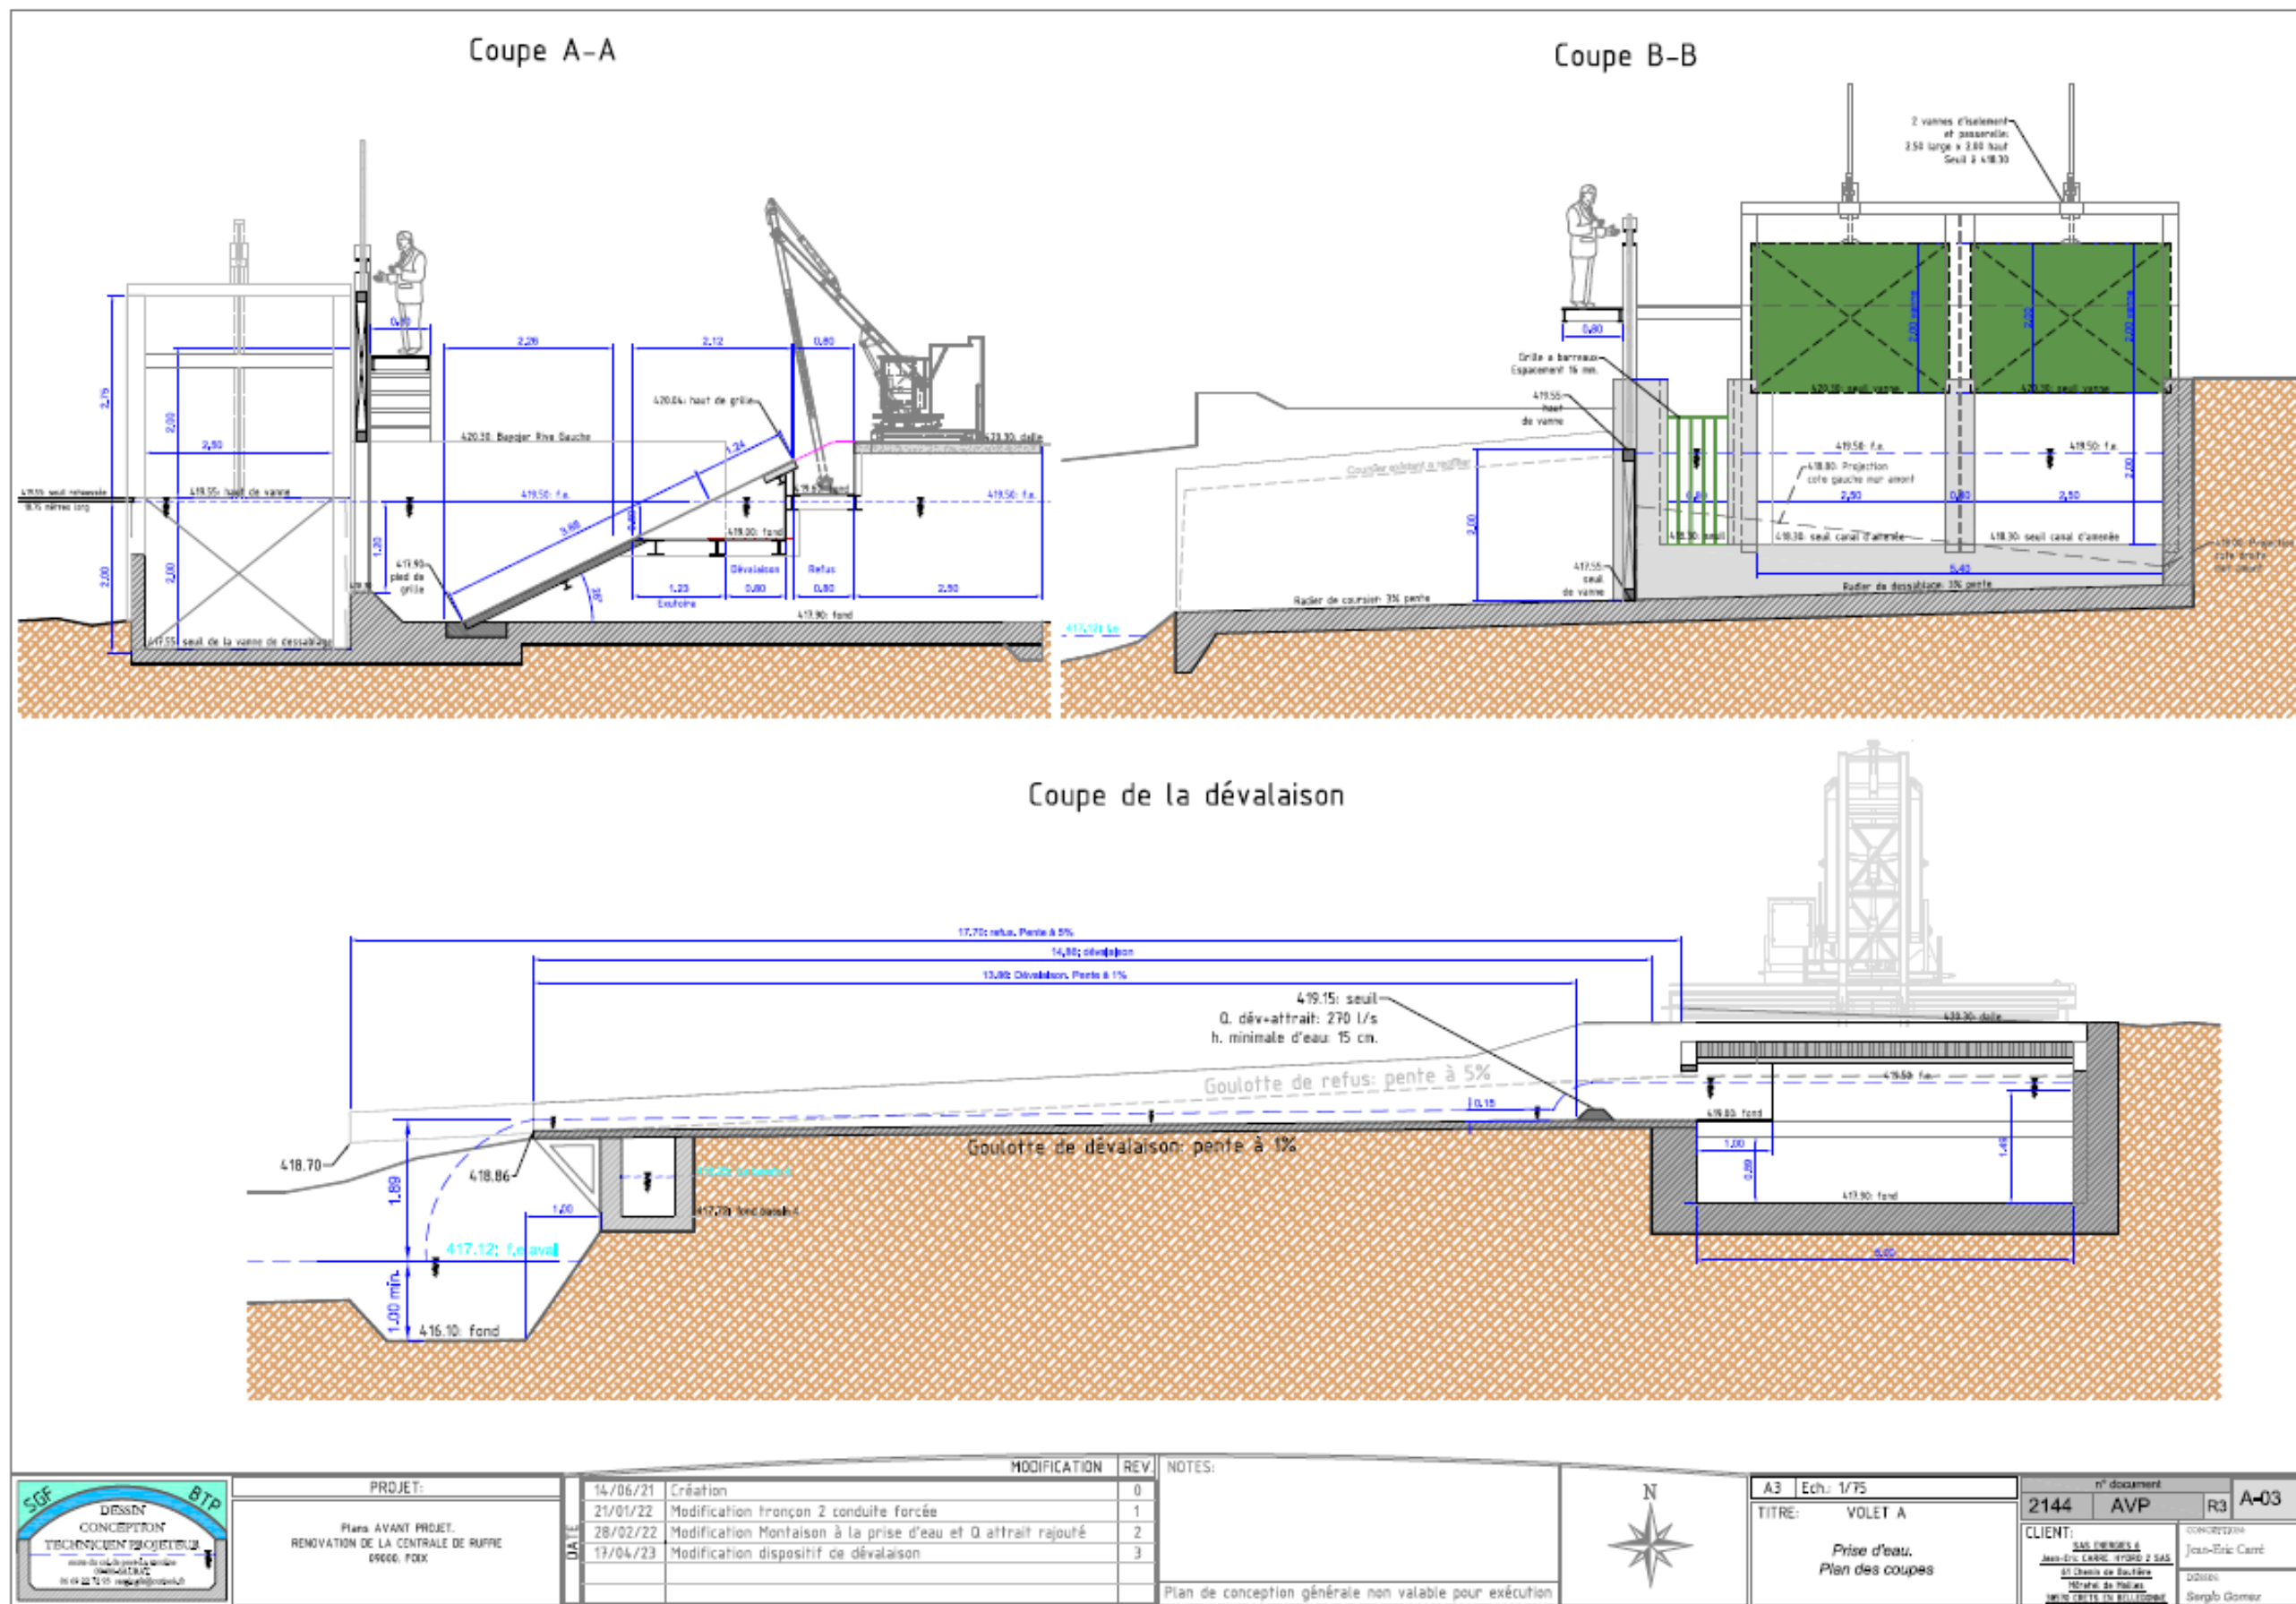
Dessin technique vue en coupe de la prise d'eau réaménagée
